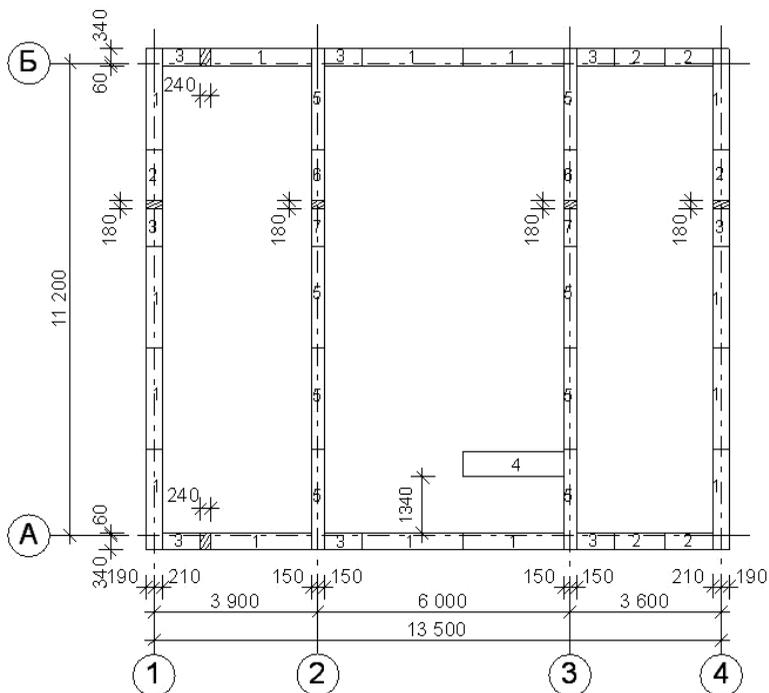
Раскладка 2-го ряда фундаментных блоков
